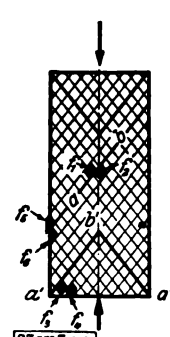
Prismatischer auf Druck beanspruchter Körper.
